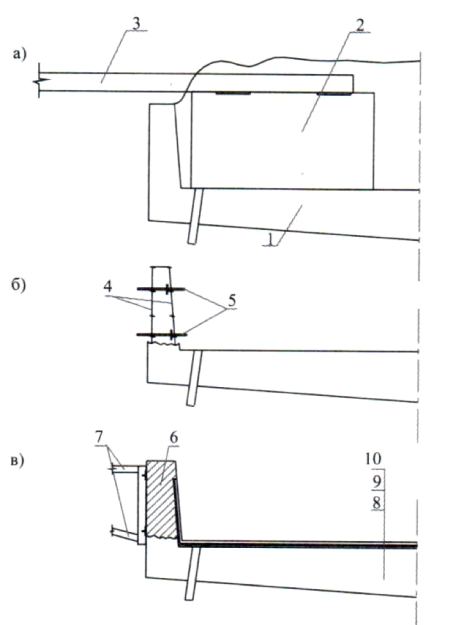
Схема ремонта железобетонного балластного корыта
